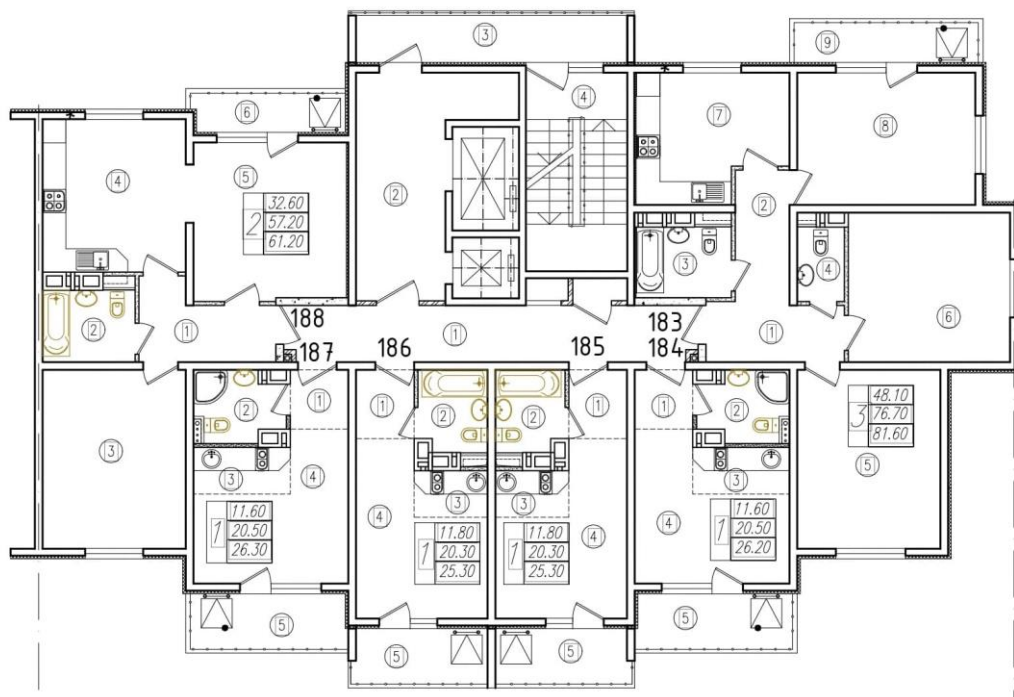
План 2-5-ого этажей 4-ой блок-секции 1 литера ЖК «Горный квартал» (тип 3)
